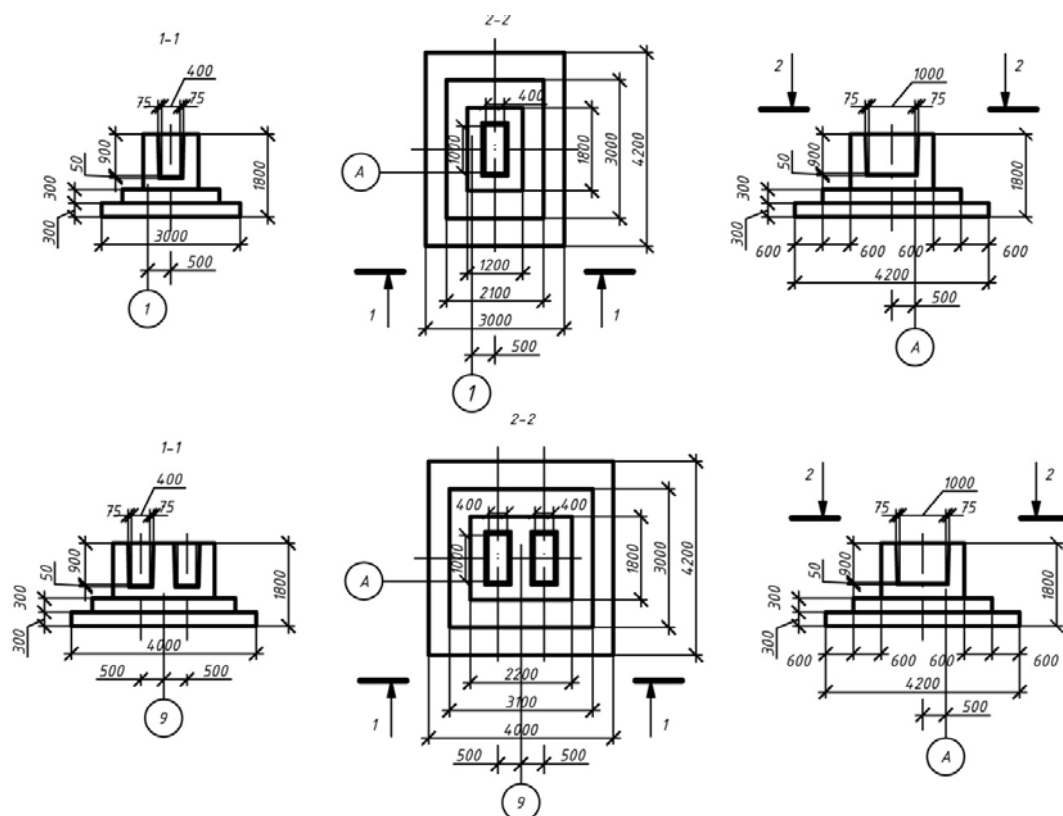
Схема фундаментов, расположенных по оси А
